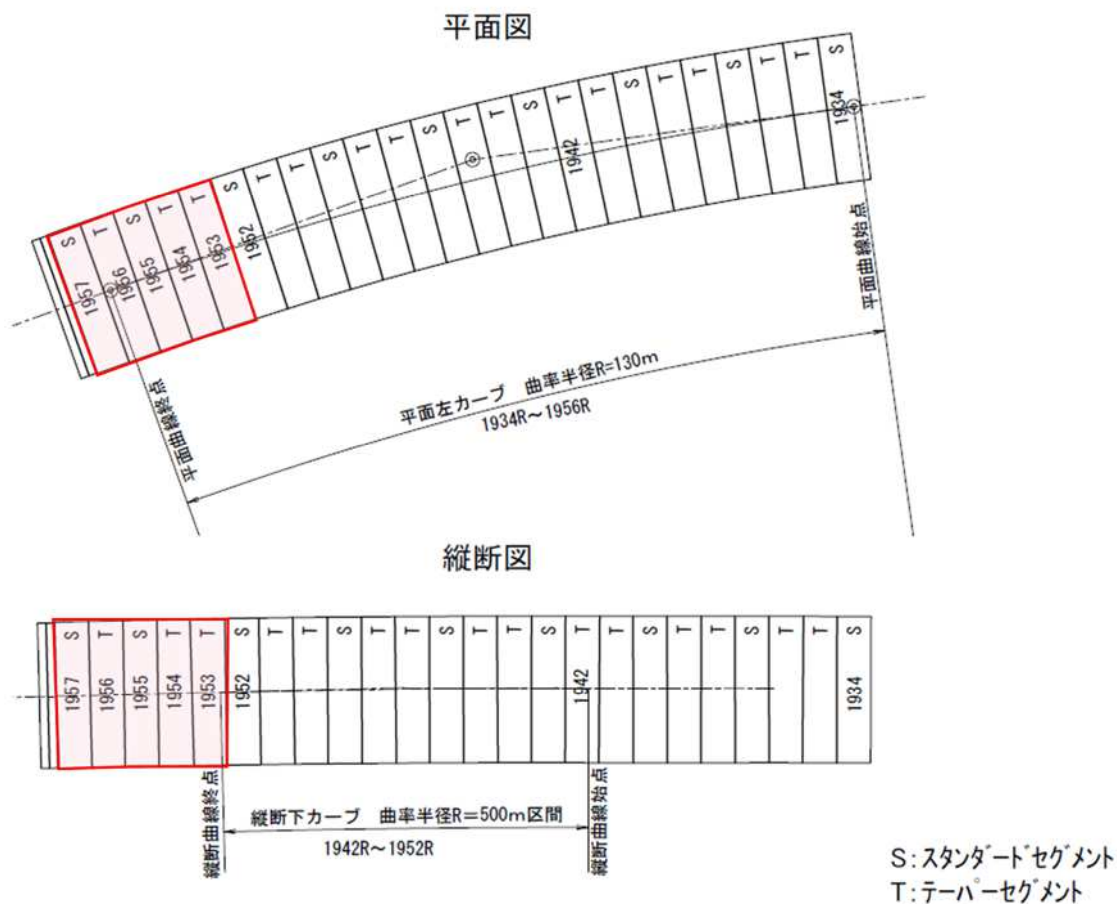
1953 リング～1957 リング付近平面図、縦断図
